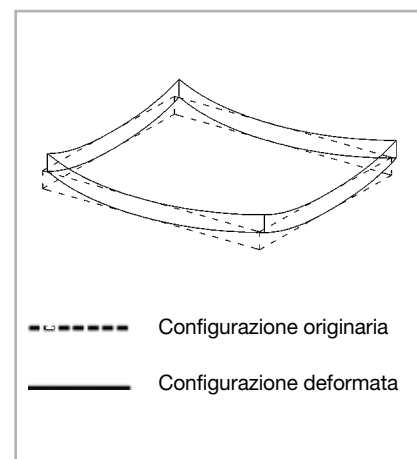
Tipica deformazione a "vela" di una campitura di pavimentazione soggetta al fenomeno di imbarcamento (curling)
